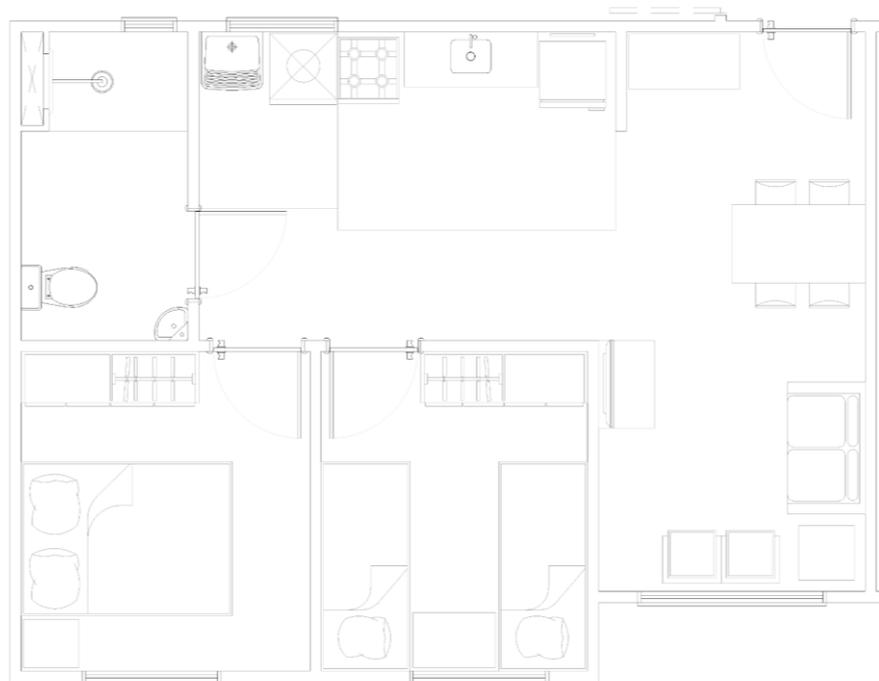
Layout para apartamento de 44,50m<sup>2</sup> disponibilizado pela construtora
